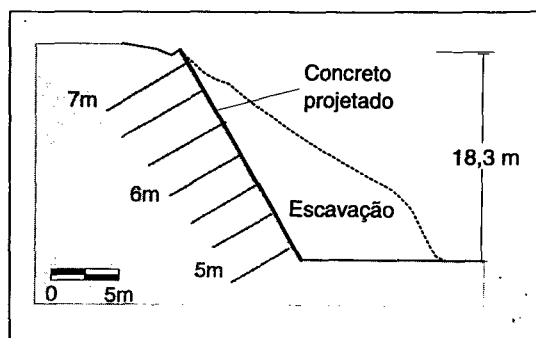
Contenção de escavação próxima a um prédio existente em saprolito de gnaiss, Taboão da Serra, SP (Obra nº 8).
